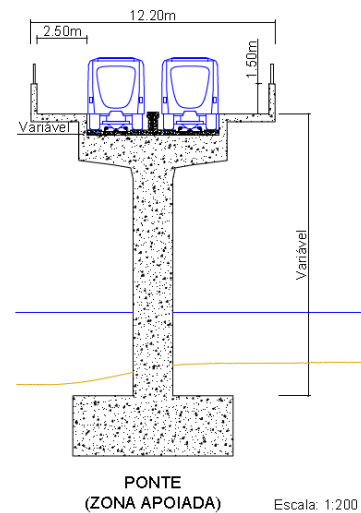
Ponte - Zona apoiada (Seção Transversal)
